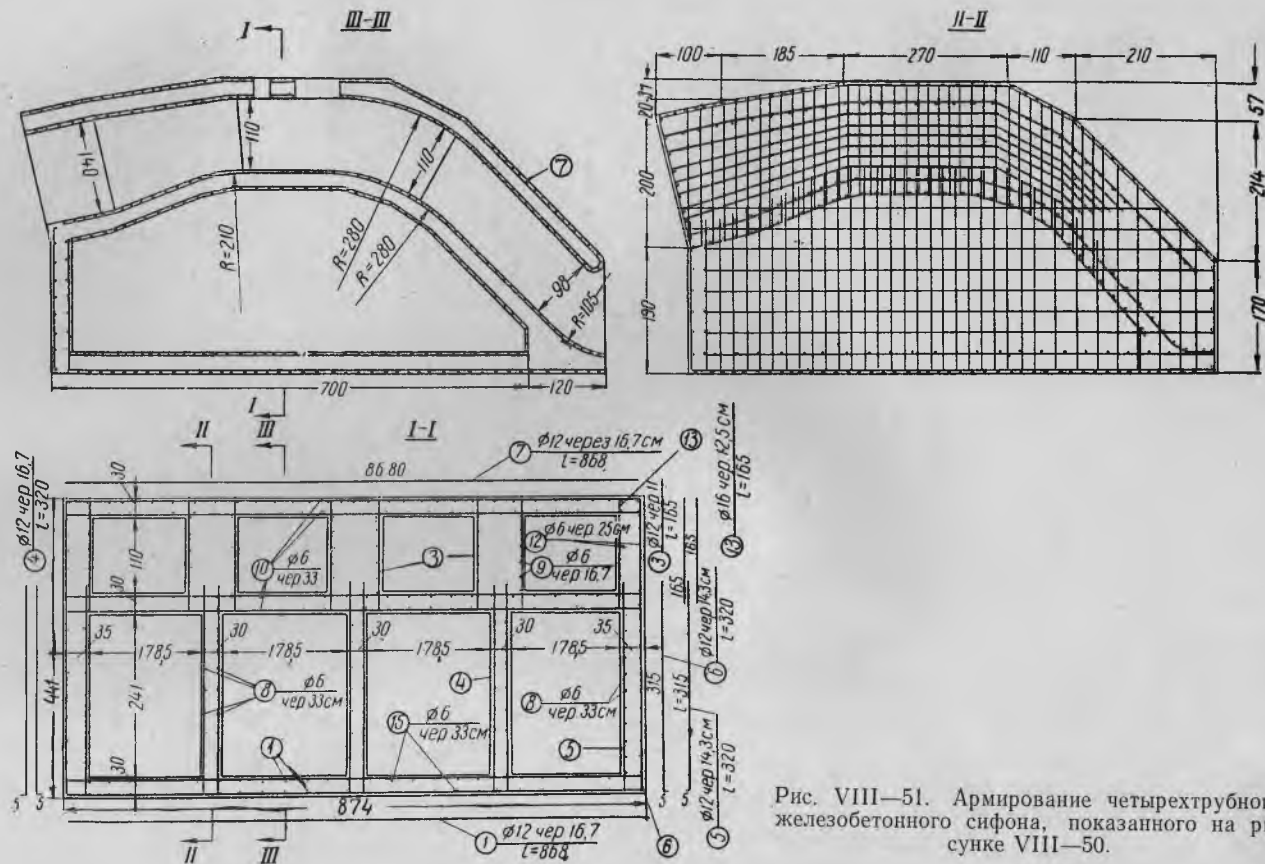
Армирование четырехтрубного железобетонного сифона, показанного на рисунке VIII—50.
